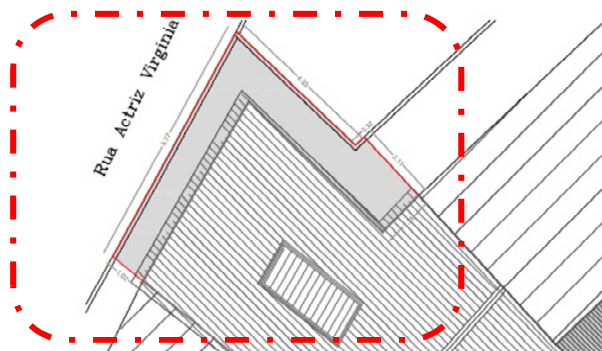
Representação esquemática do limite de ocupação da via pública, na planta de implantação.
